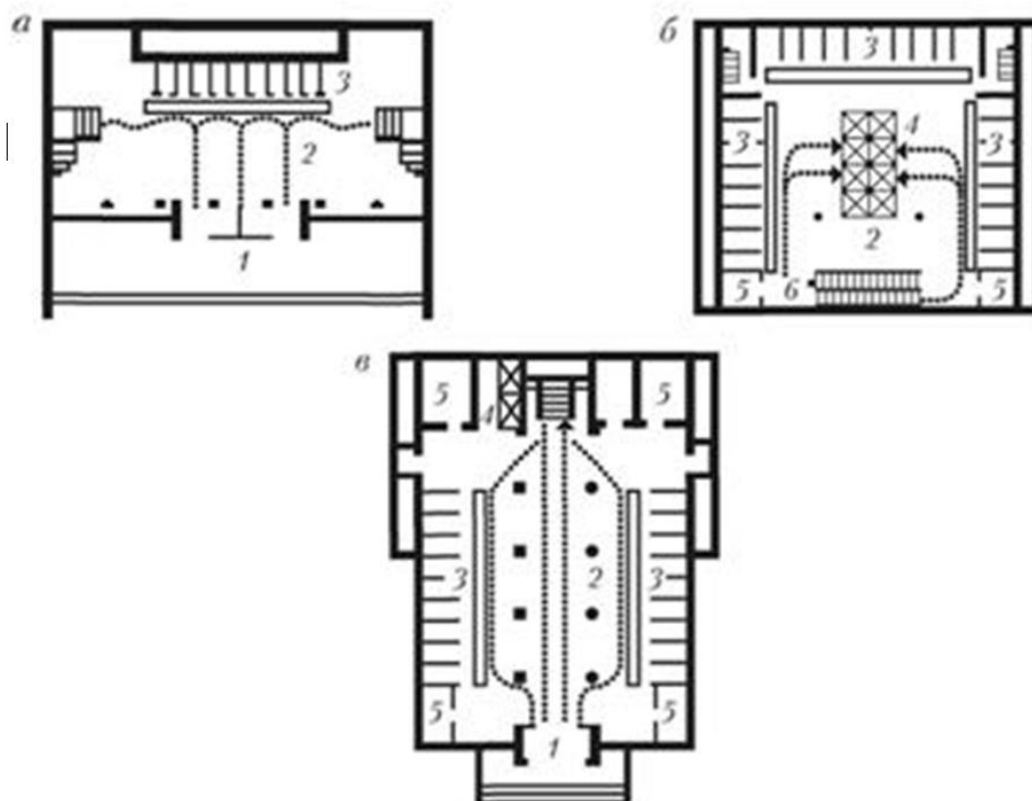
Планувальні схеми вестибюлів в громадських будівлях:
